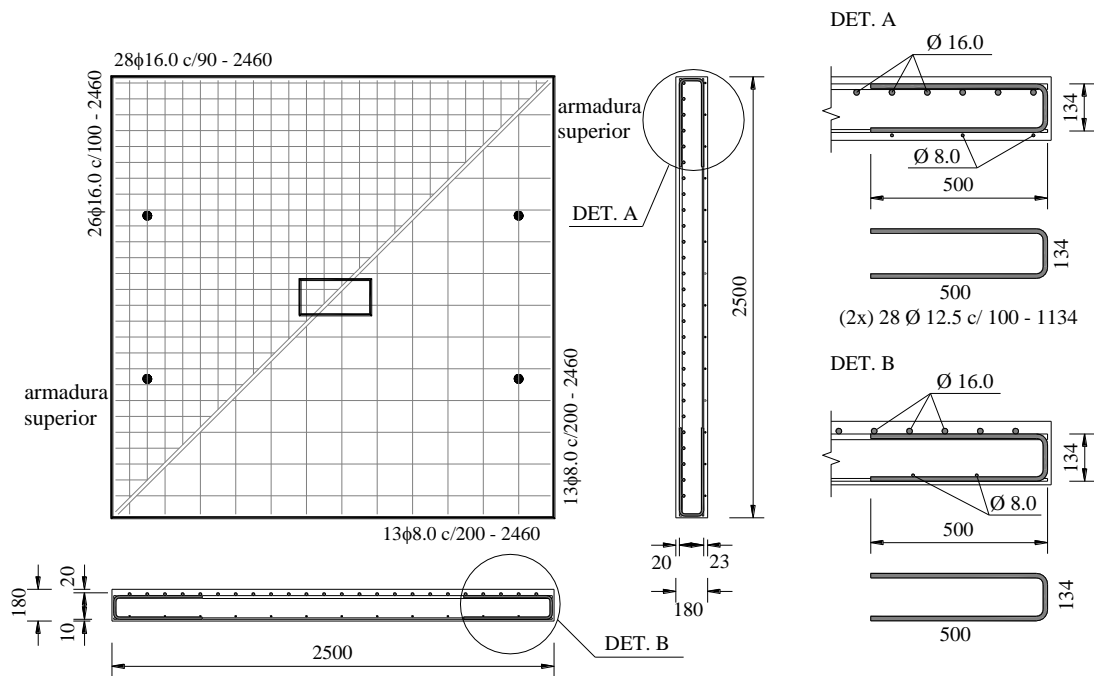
Armadura inferior para todas as lajes dos modelos LW01, LW02 e LW03.
